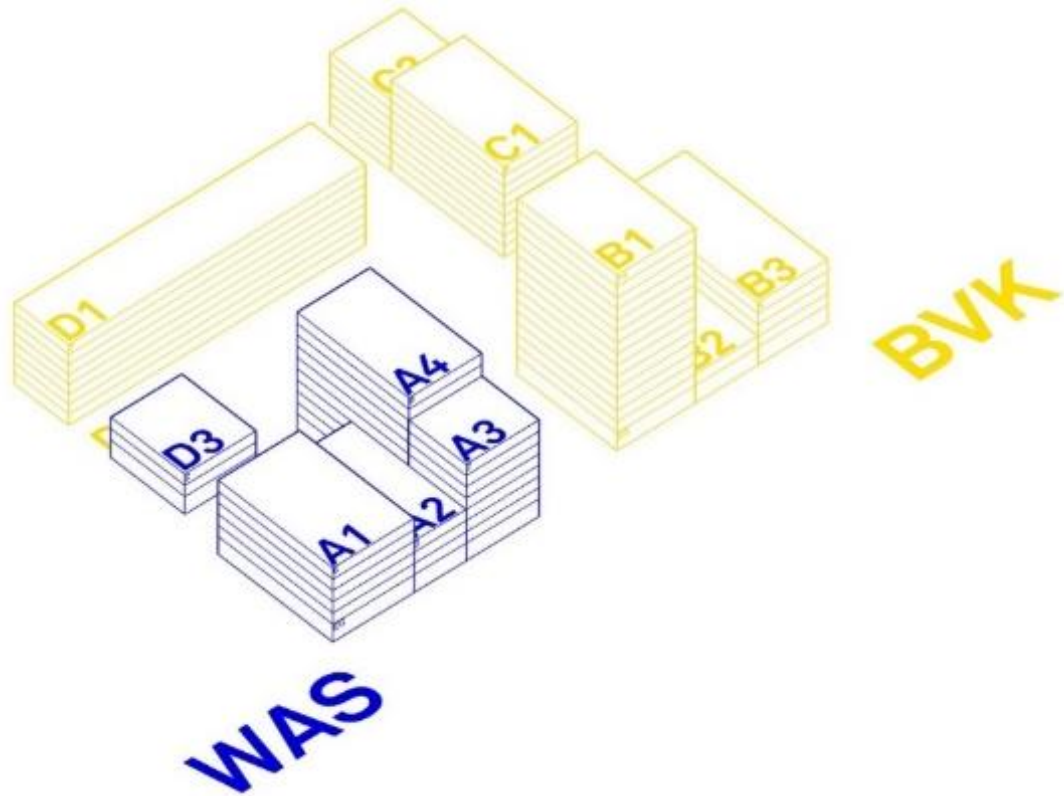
Isometrie Bebauungsplan Eichhof West mit Aufteilung der Bauvolumen
